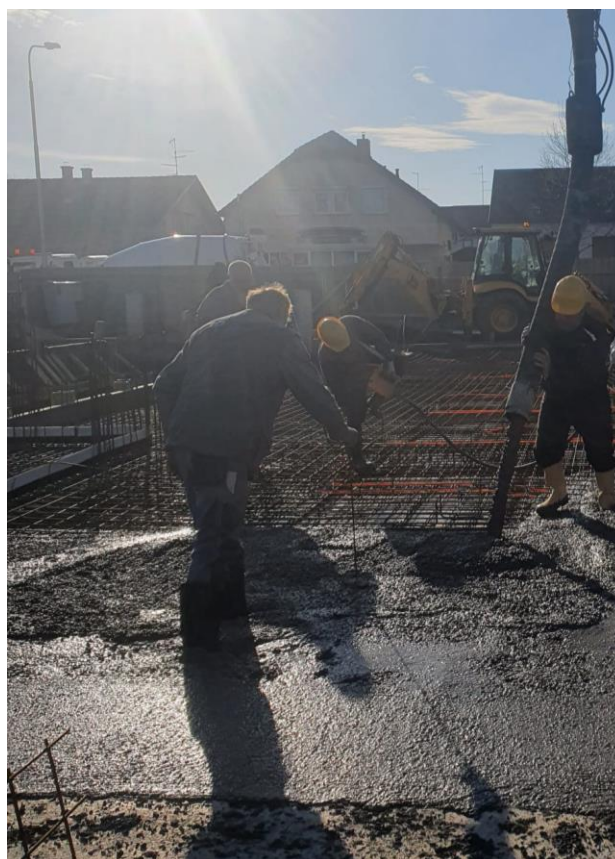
Početak betoniranja stropne ploče podruma zadnje trećine pumpom za beton
